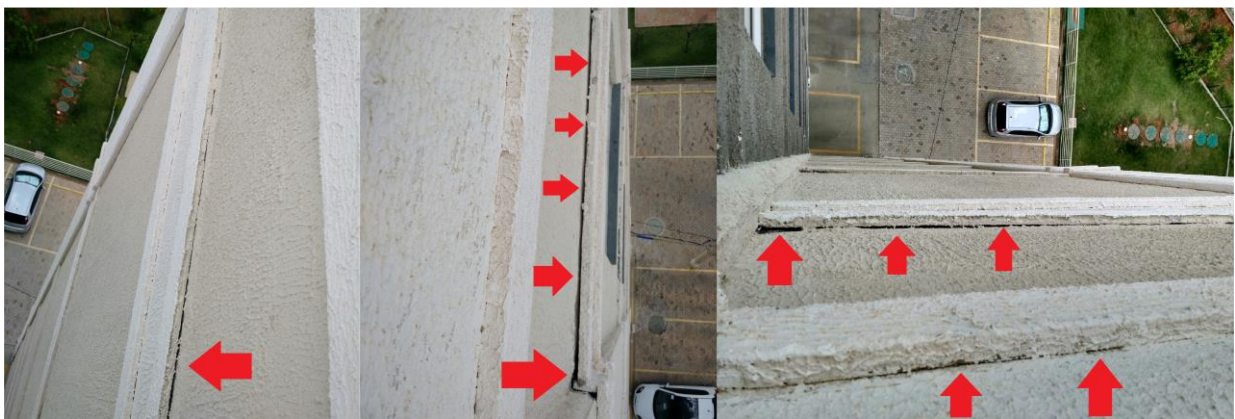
Corte da viga e dos painéis evidenciando o ponto de infiltração. Fonte: Arquivo Pessoal
